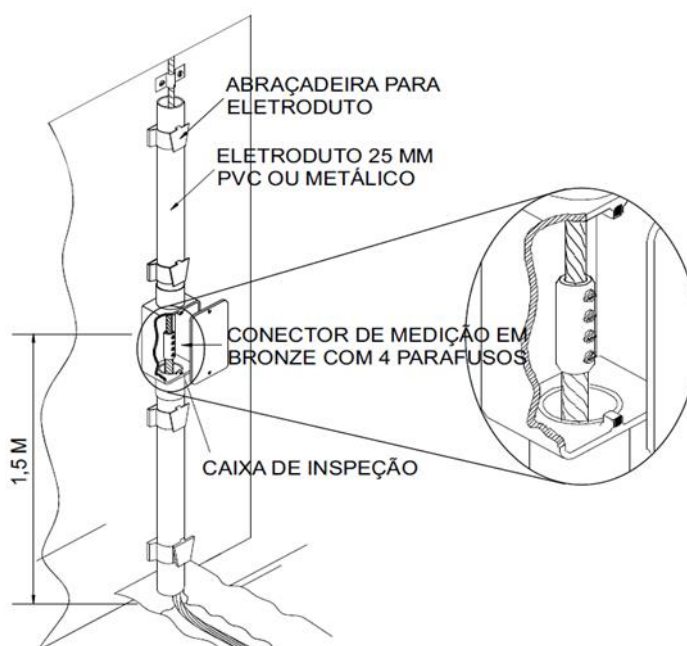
Detalhe da instalação da conexão de ensaio para condutores de descida na parede de alvenaria.
